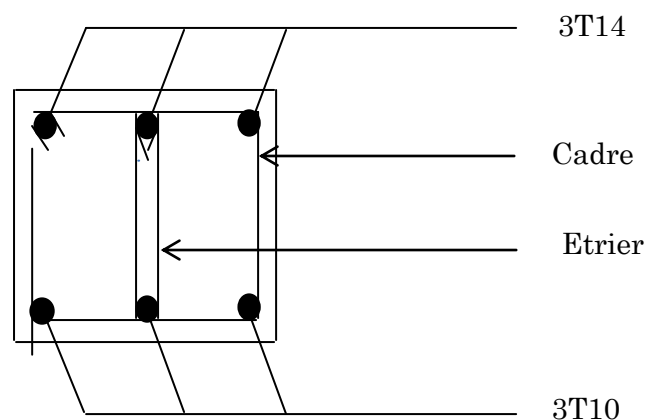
Schéma de ferrailage de la poutre de chaînage
